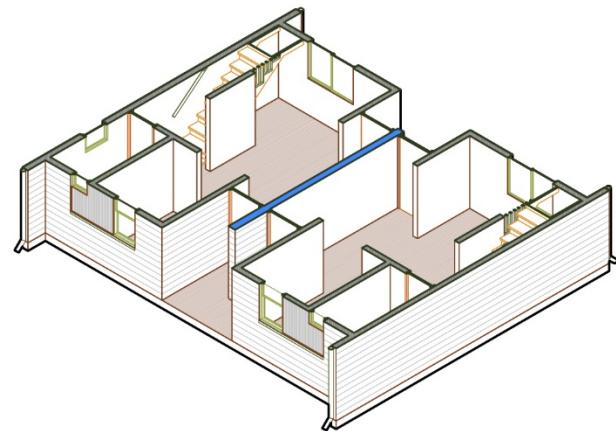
Elementos constructivos que deben cumplir con la regulación acústica, en primer piso.
